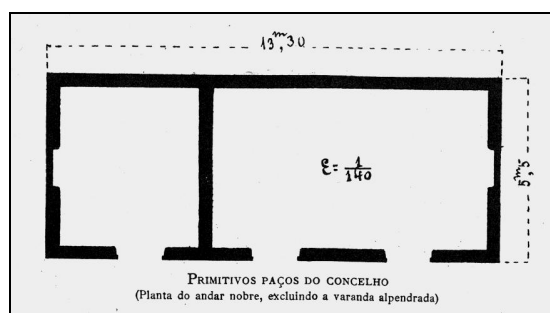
Casa de câmara e cadeia da Praia da Vitória – planta do primeiro andar.
